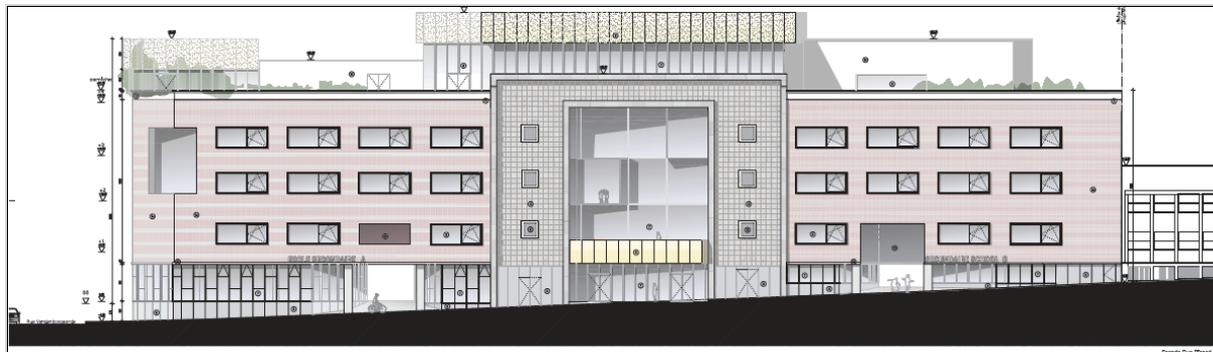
Façade du bâtiment sur la rue Picard (situation projetée)
